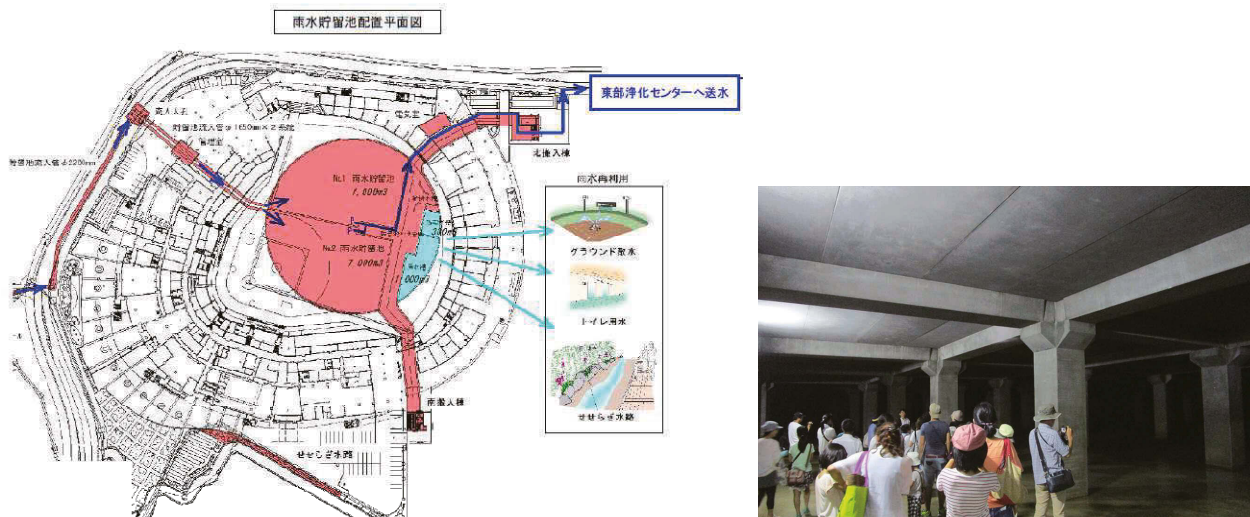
大州雨水貯留池の平面図(左)および内部(右)
